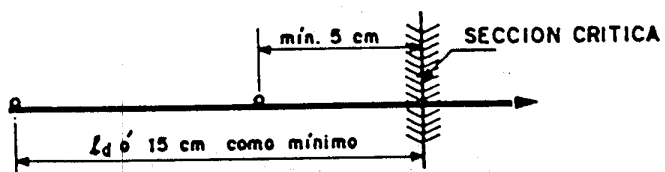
ANCLAJE DE BARRAS CON GANCHOS SEGUN LA SECCION 12.5.4
